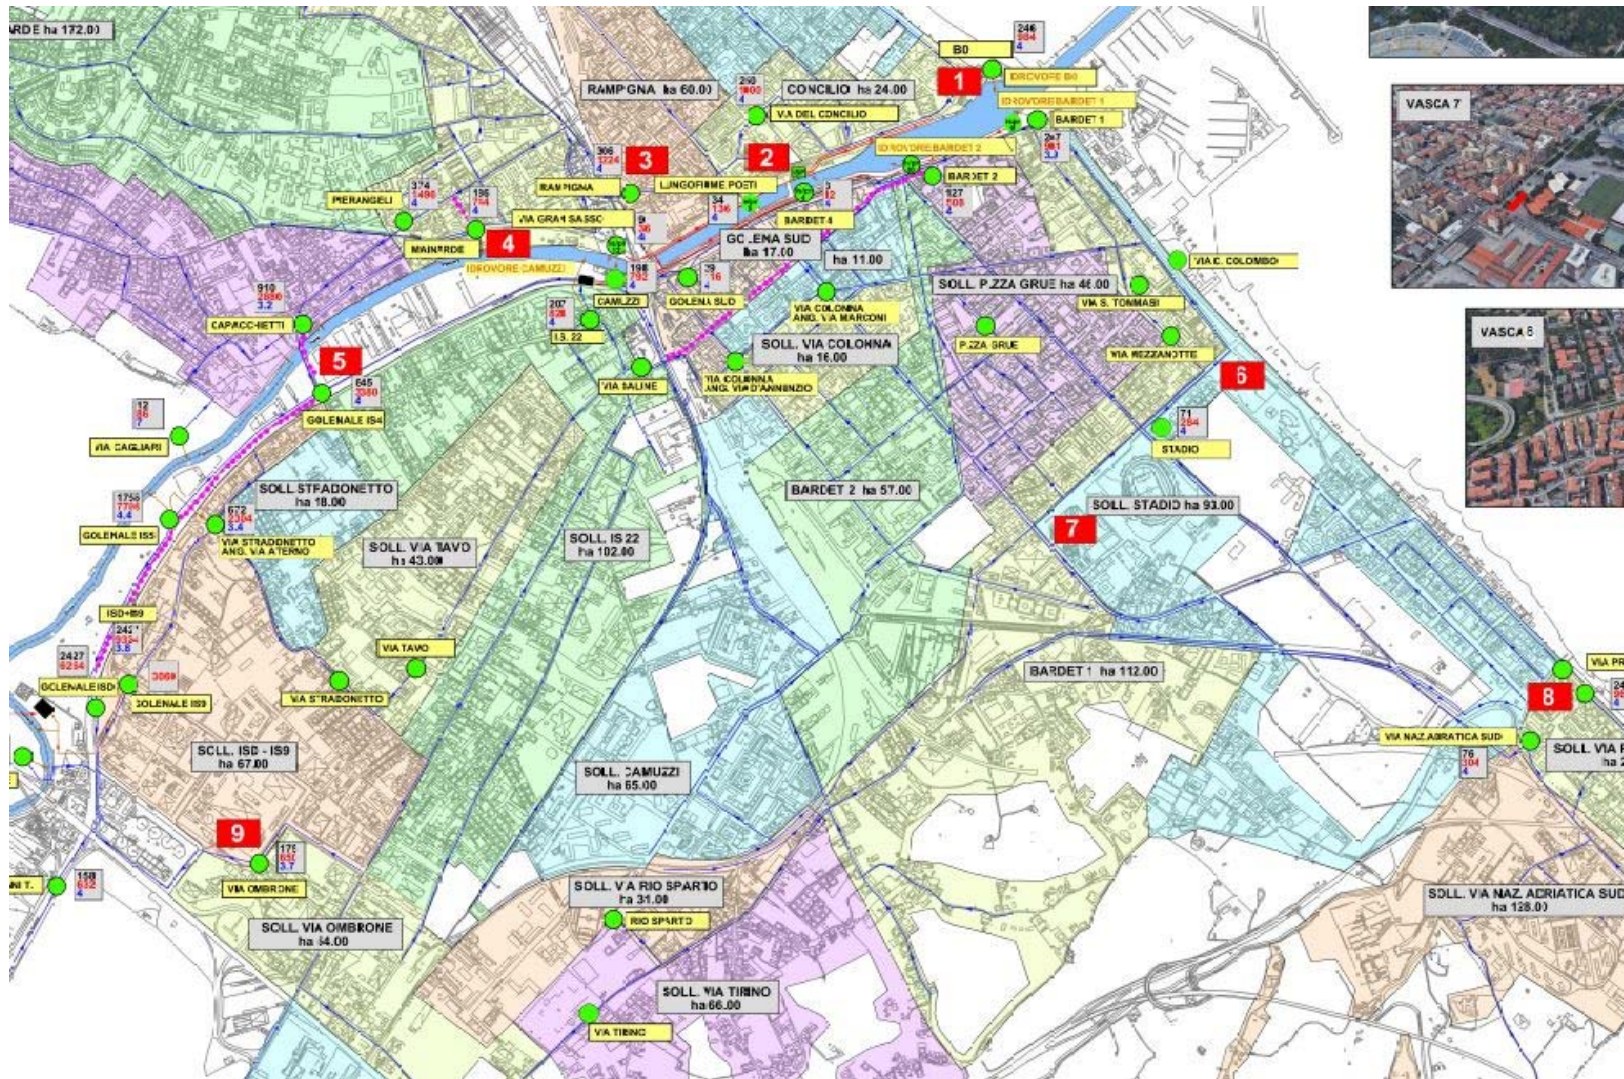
Stralcio Tav. 08.G.02 –Planimetria Generale Stato di Progetto
